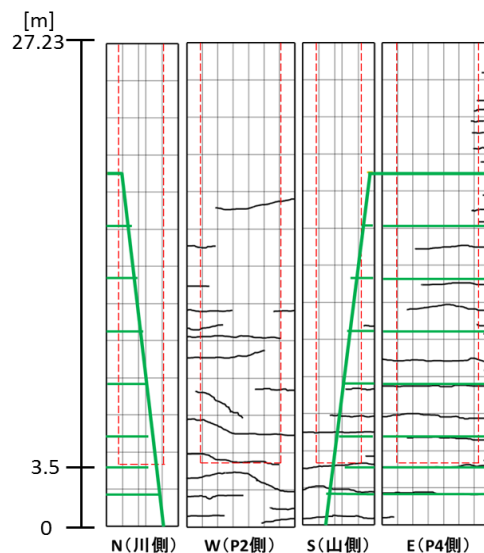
P3橋脚ひび割れ再現図(1方向)
